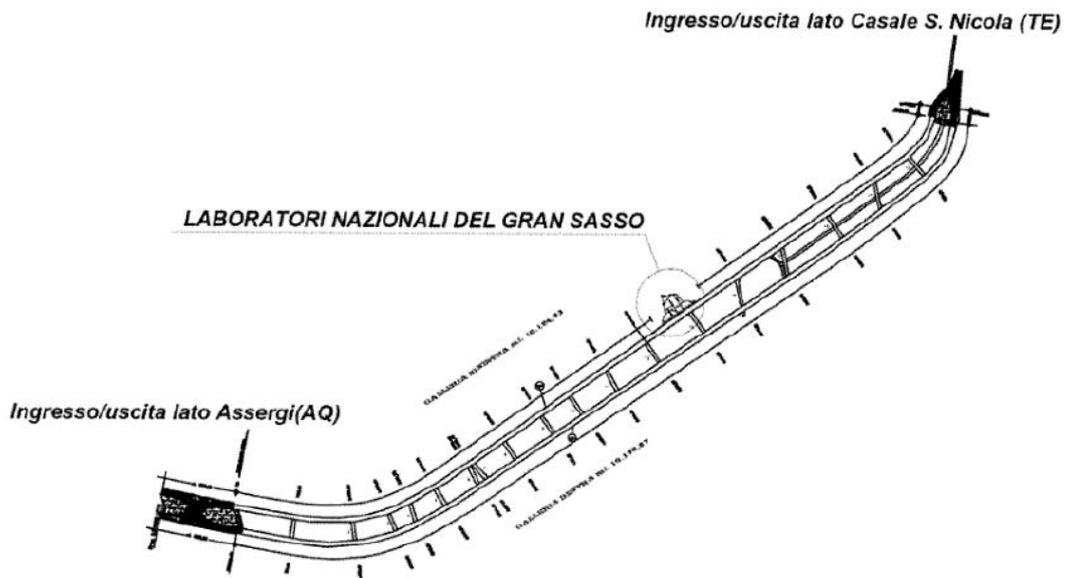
Posizione dei laboratori sotterranei rispetto alle gallerie dell'Autostrada A24
